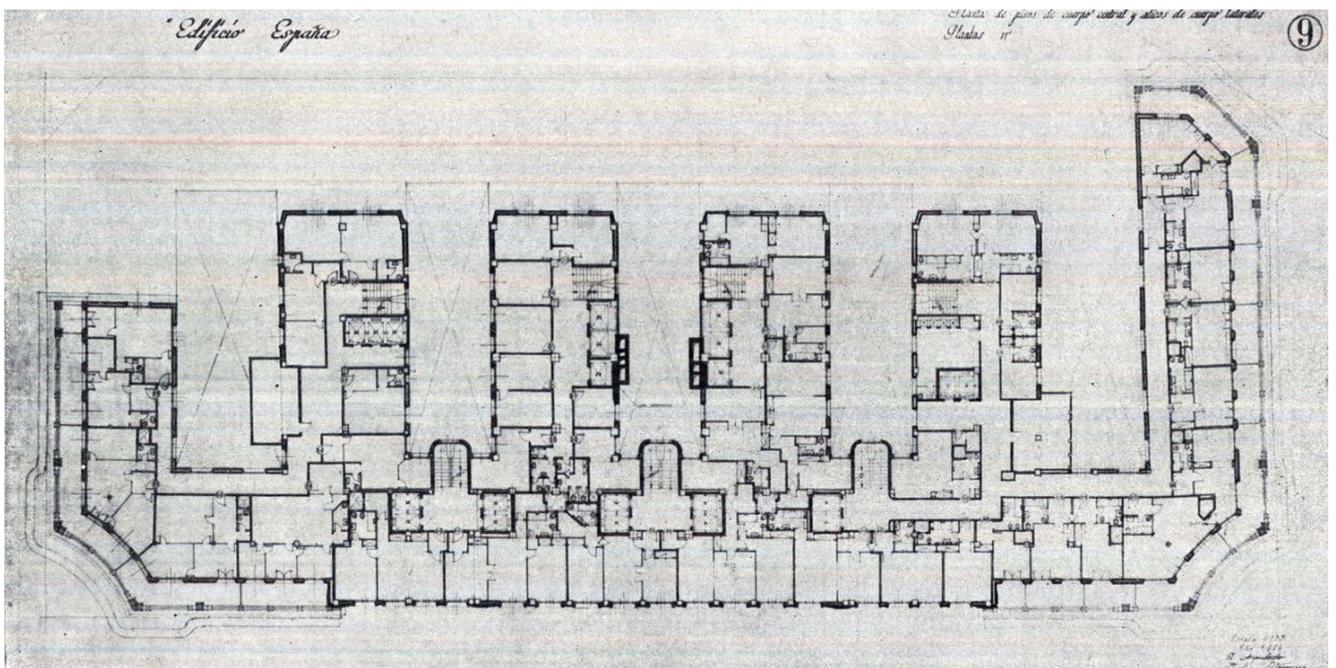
Planta 11ª, correspondiente al primer retranqueo de la fachada principal, con las terrazas corridas de los cuerpos extremos, 1949. Arquitecto: Julián Otamendi.
